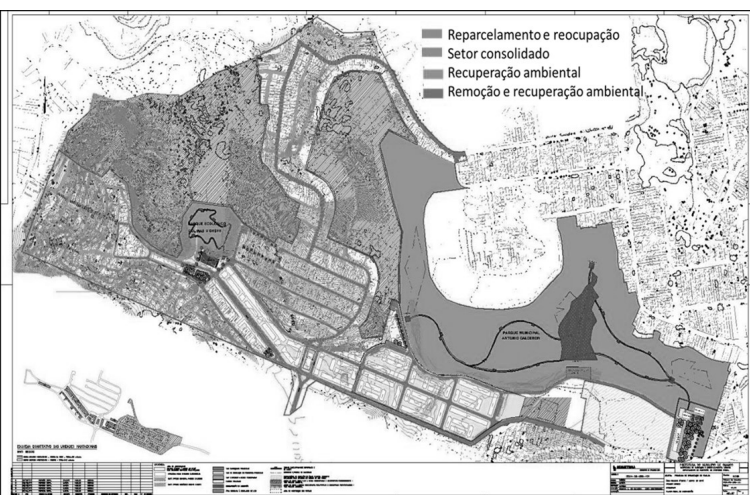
Plano Urbanístico Colinas D'Oeste
